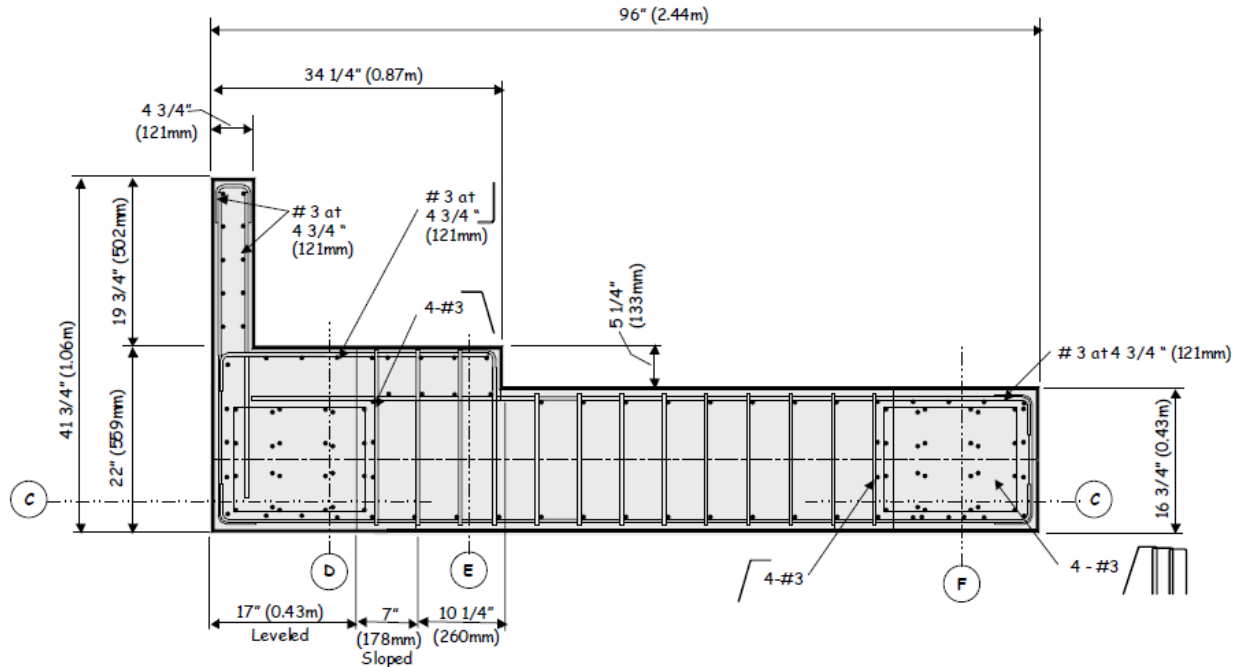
Vista en Planta de Refuerzos – Serie 1 Externa (Megally et al., 2002).
